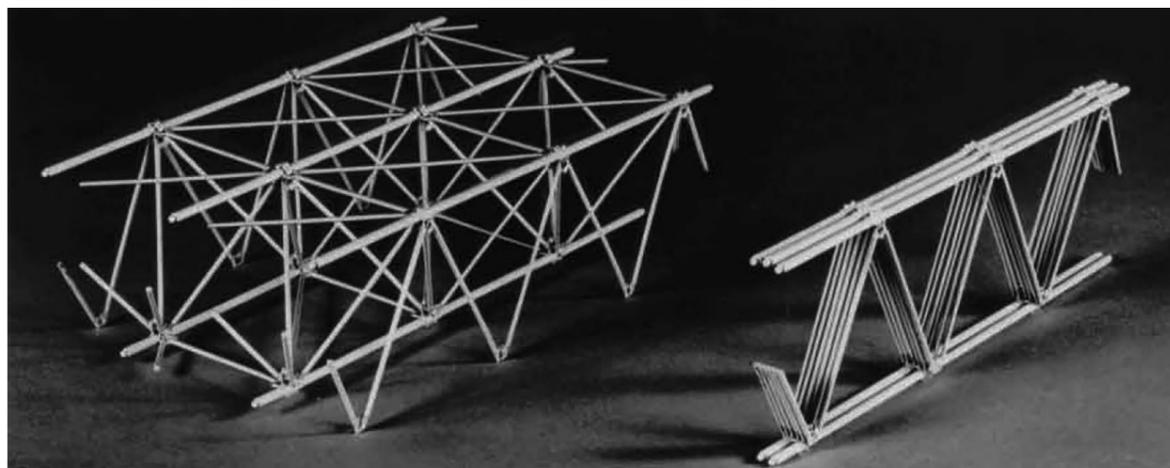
; 48 - Maquete do sistema; Componentes do sistema em tamanho real
